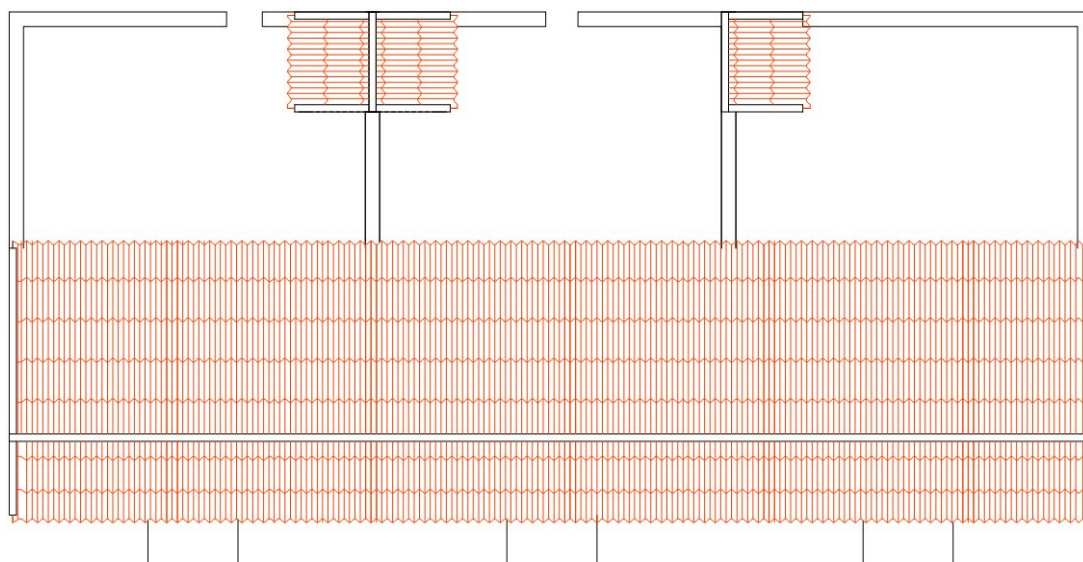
Planta cobertura de Aquartelamento dos guardas auxiliares
